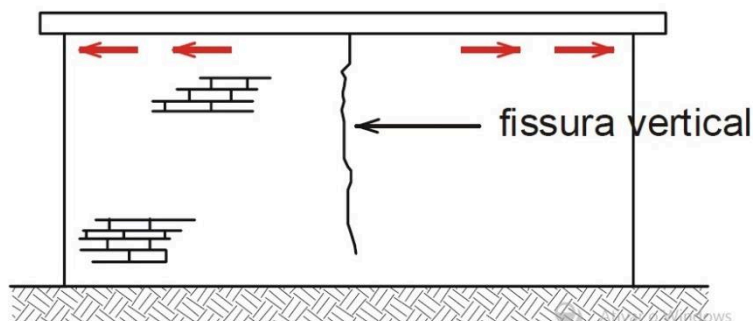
Fissura vertical por movimentação térmica da laje (DUARTE, 1998).
